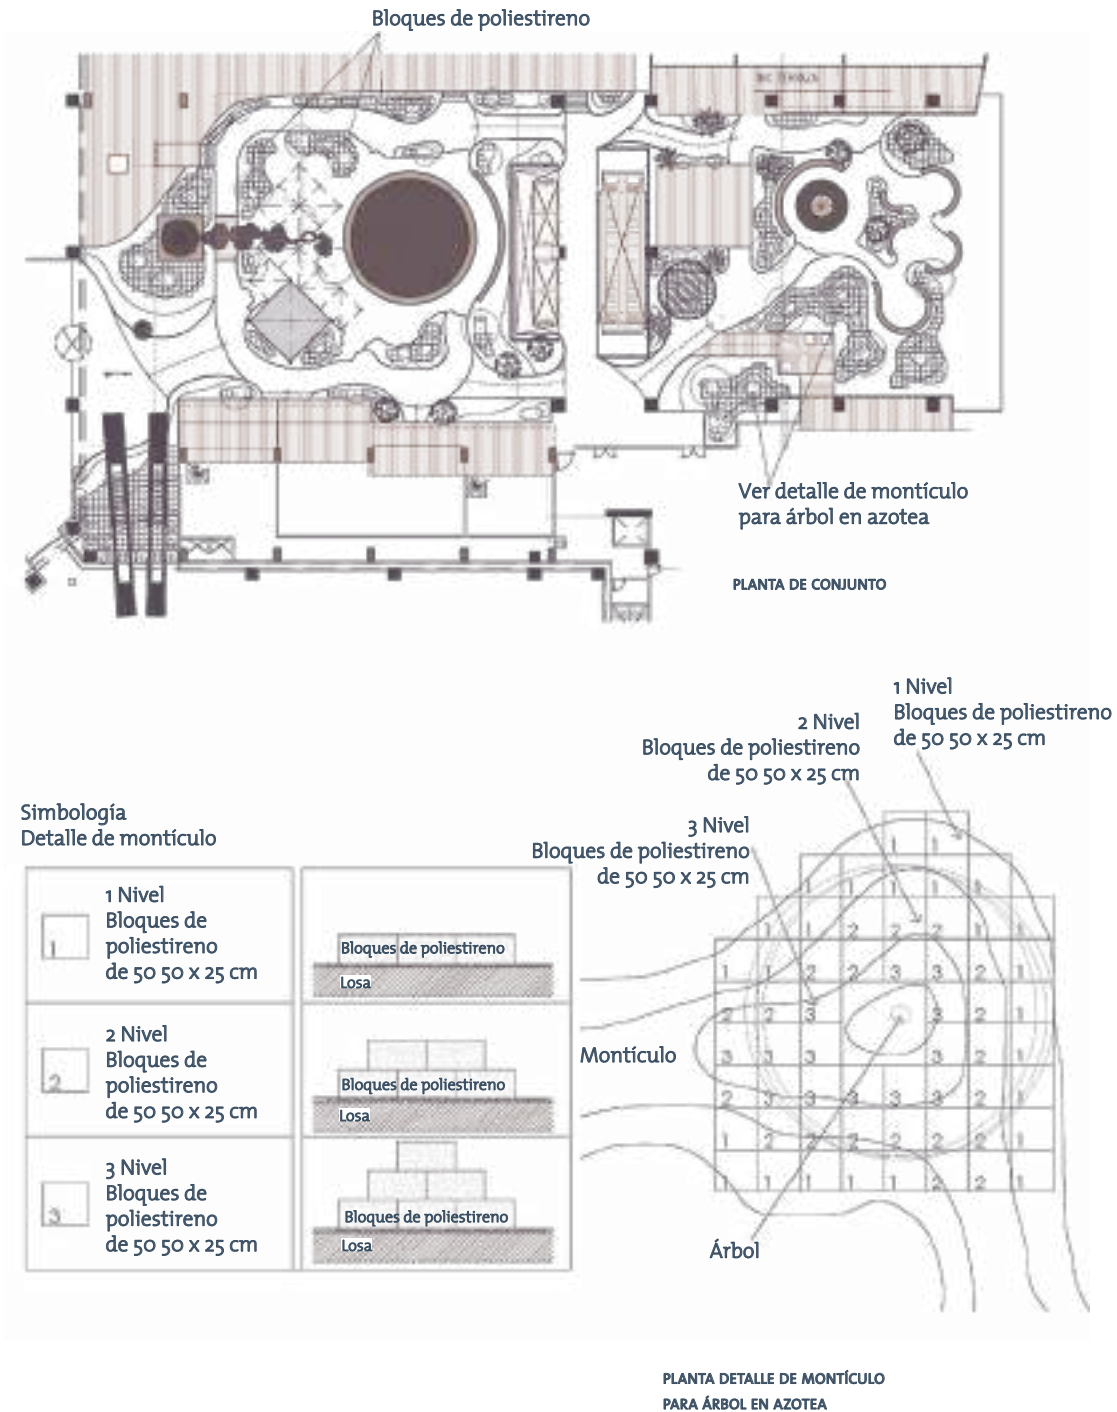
Detalles de jardín sobre estructura, Parque Refoma
